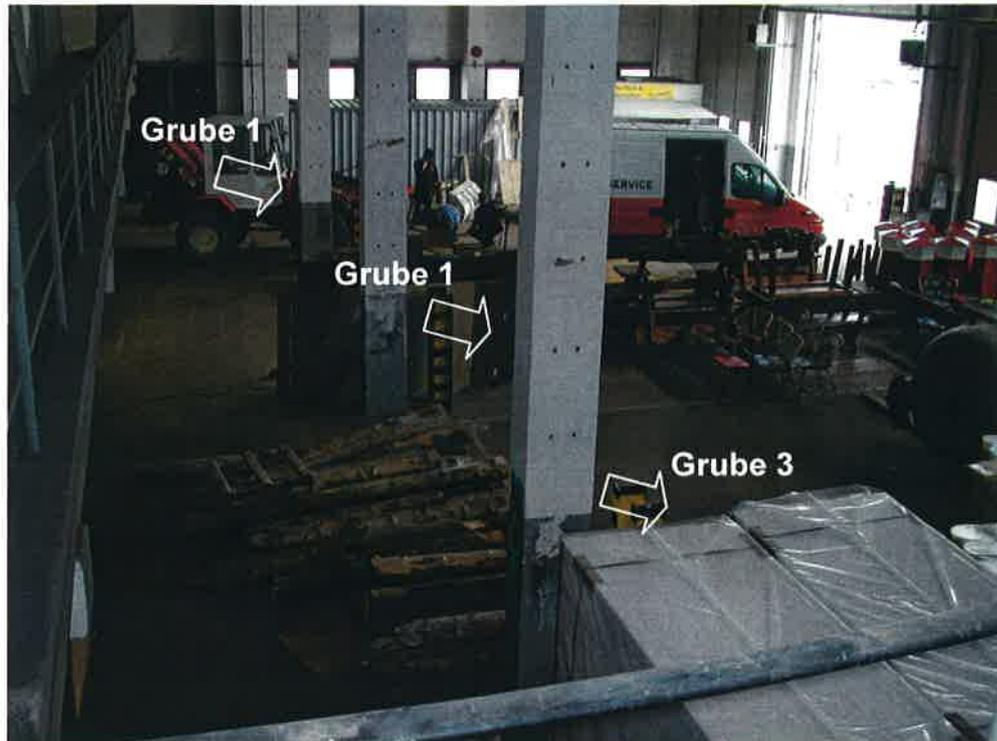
ehem. Panzerhalle - Innenansicht (Lage der Montagegruben)
